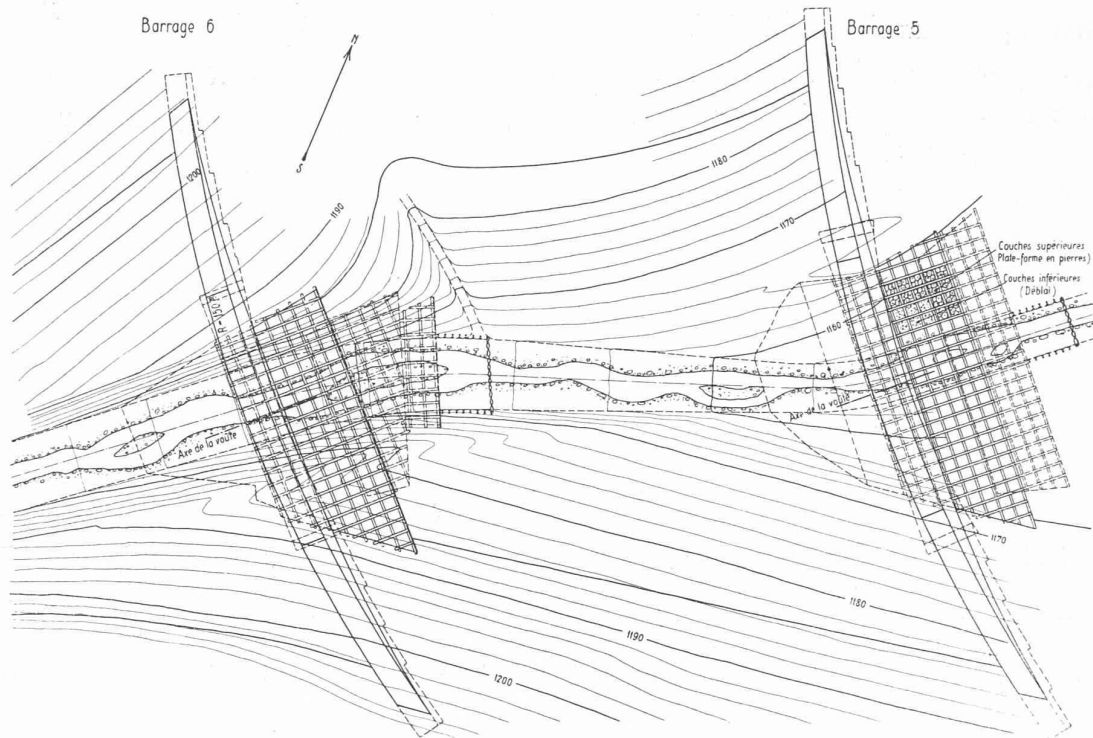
Plan de situation des barrages 5 et 6. — Echelle 1 : 800.
